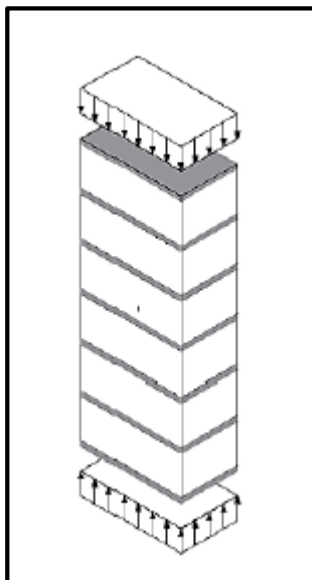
Pila de albañilería en compresión. Tomada de “Macromodelación de pilas y muretes de albañilería”, por Ruiz, 2017, p.26.
